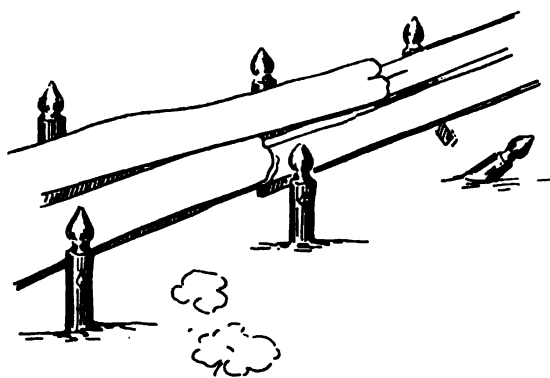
Passerelle en planches sur un bassin-fossé.
